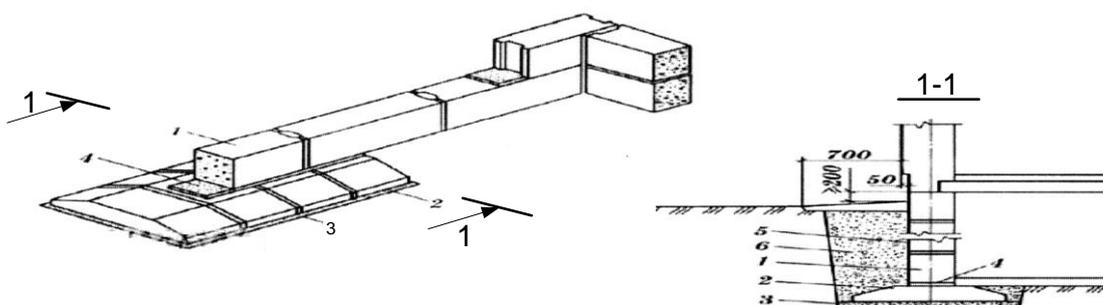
Ленточный фундамент из сборных бетонных блоков: 1 - бетонные блоки; 2 - железобетонные подушки; 3 - песчаная подушка; 4 - гидроизоляция (цемент-ный раствор состава 1:2); 5 - обмазка горячим битумом за два раза; 6 – обратная засыпка
